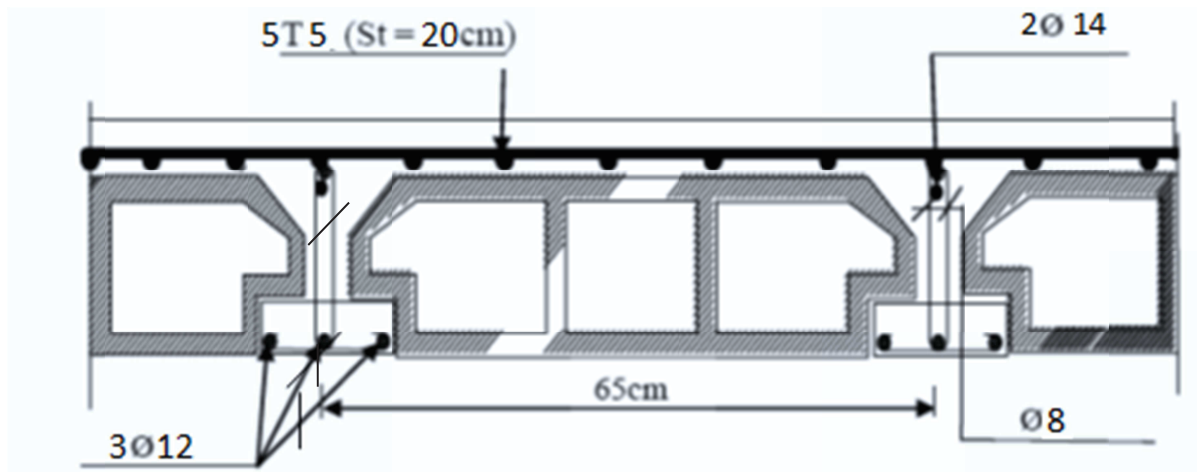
plan de ferrailage du plancher en corps creux.
